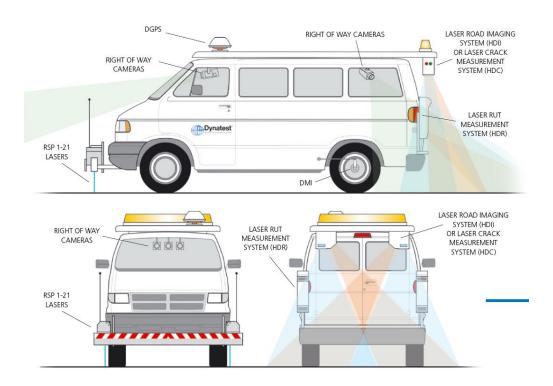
Equipos de relevamiento de la condición superficial del pavimento. Fuente: Curso de Capacitación de Mantenimiento de pavimentos – AdP
